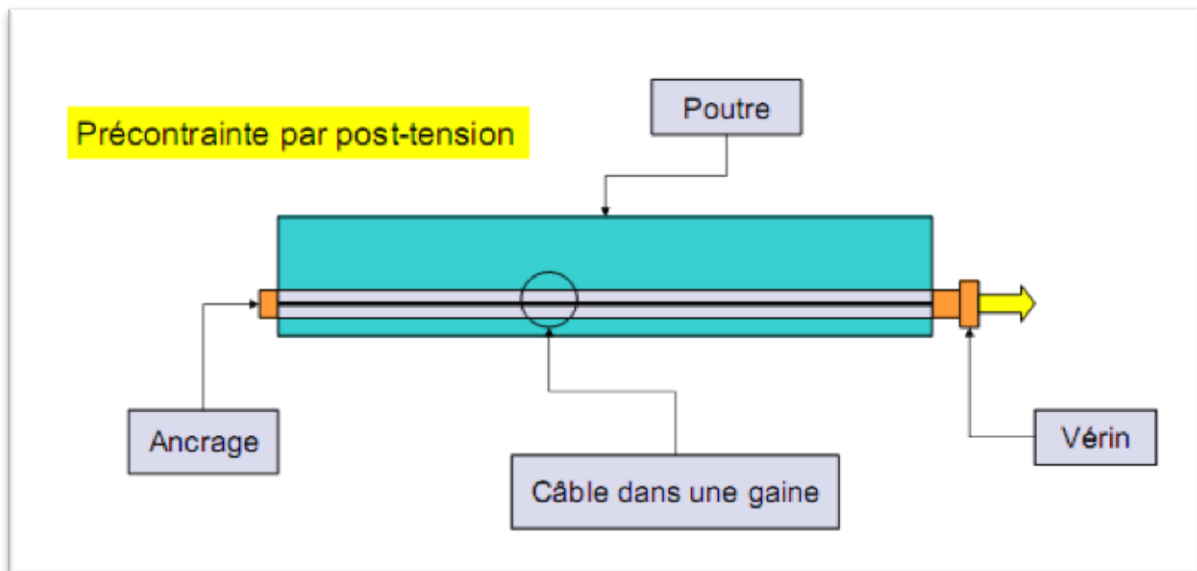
Coupe longitudinale d'une poutre en béton précontraint par post tension
